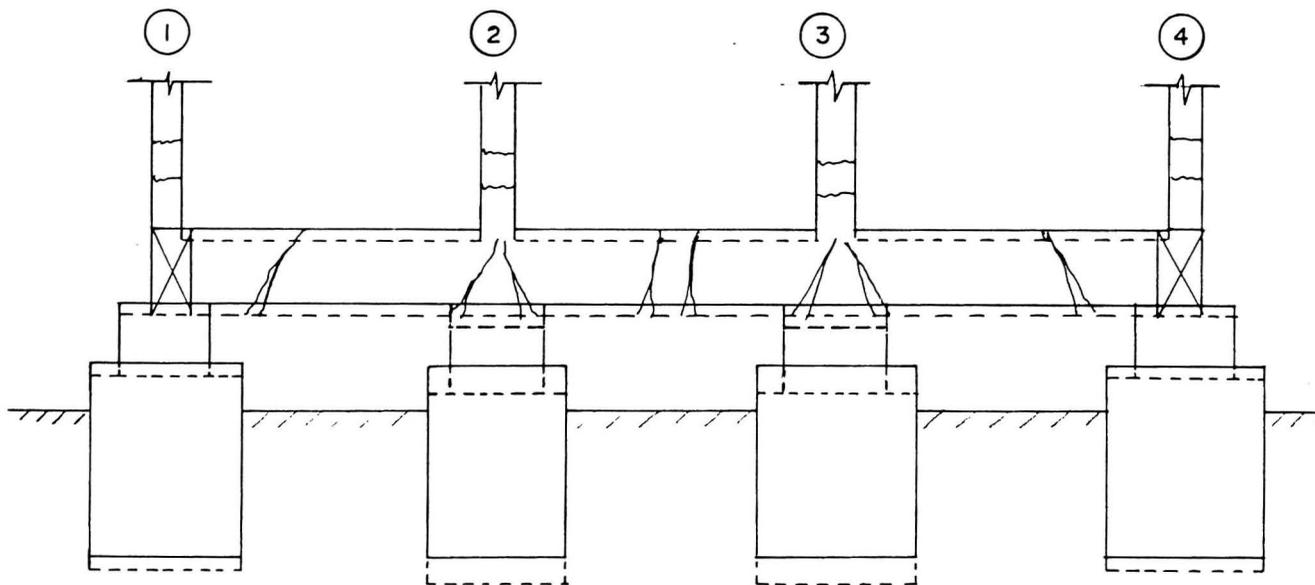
Esquema de deformación y fisuras. Fachada W - Bloque 2.
